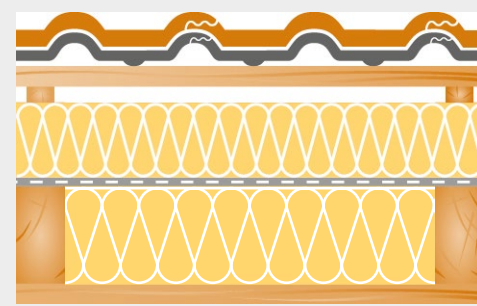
Ausgebautes Dachgeschoss unter Verwendung einer Aufsparrendämmung
